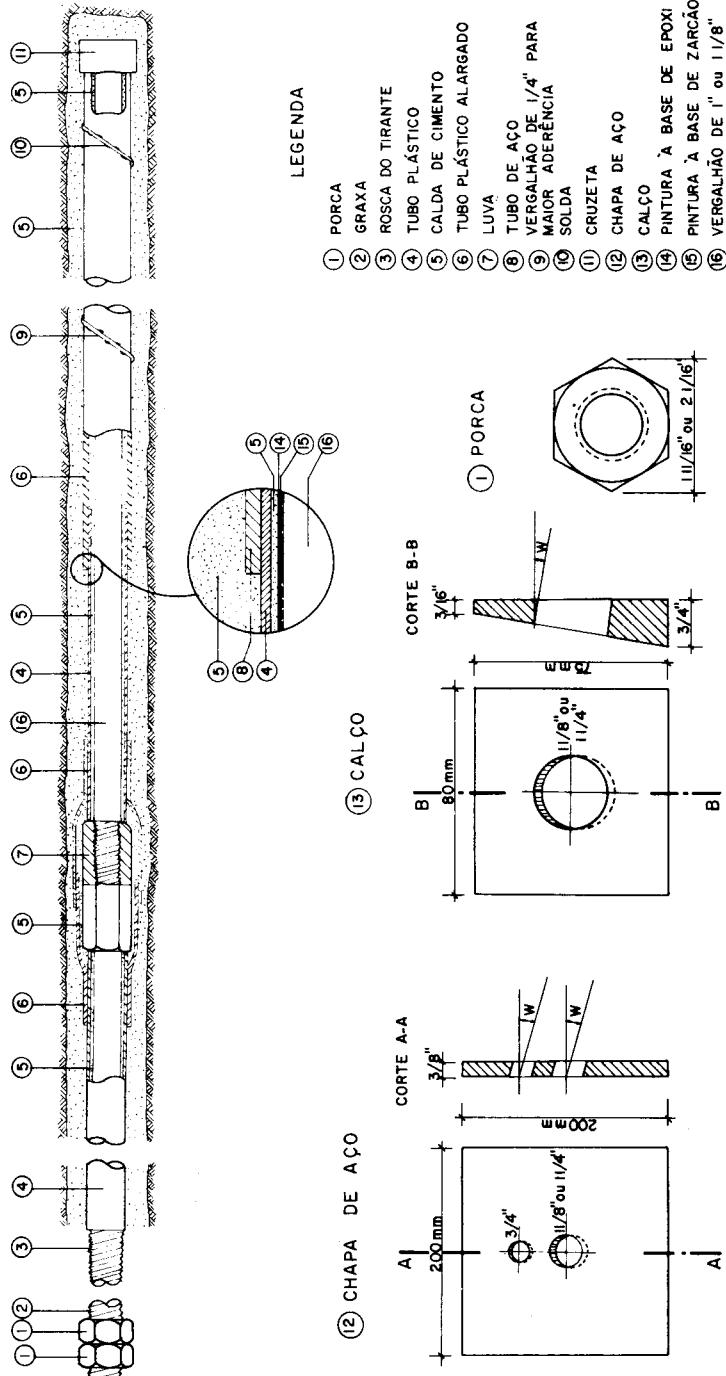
Tirantes de aço em barra Ø 1" e 1 1/8" – Acessórios (sistema TECNOSOLO - proteção contra a corrosão com 5 camadas)
